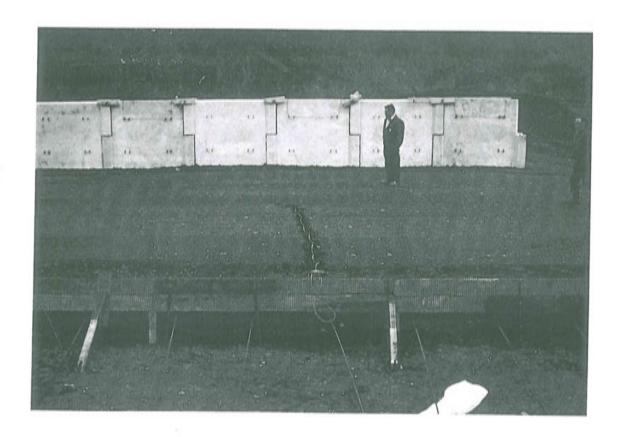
Estructura de tierra reforzada. Instalación de termopar.
